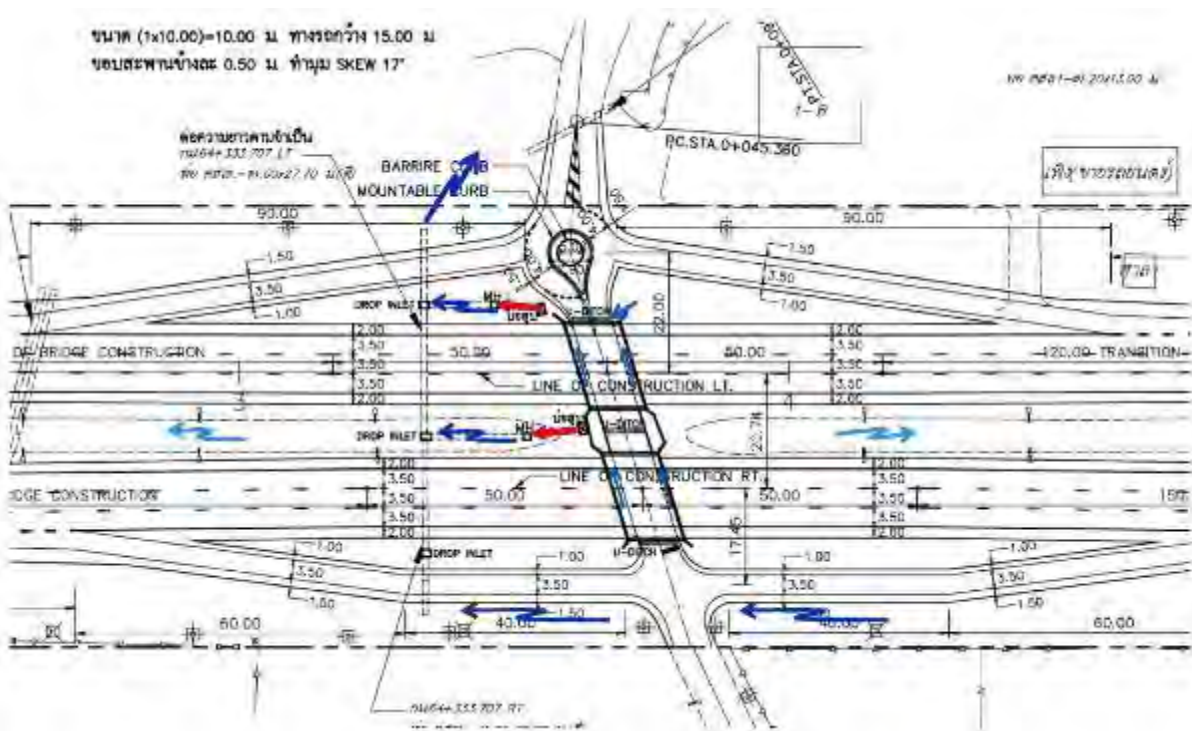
(Cont.) The construction plan and traffic patterns, including drainage, at the Po Koi intersection area
